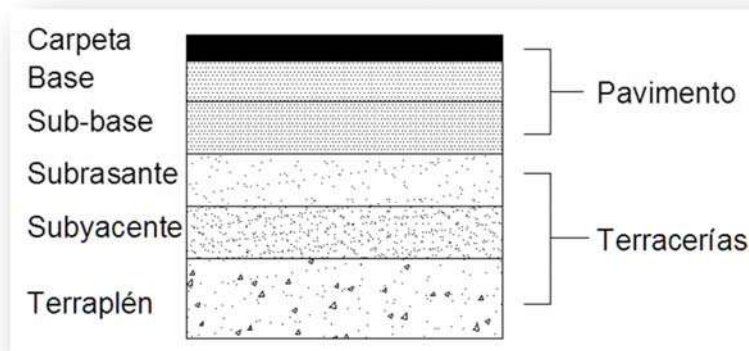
Capas que conforman a un pavimento asfáltico. Fuente: Elaboración propia
